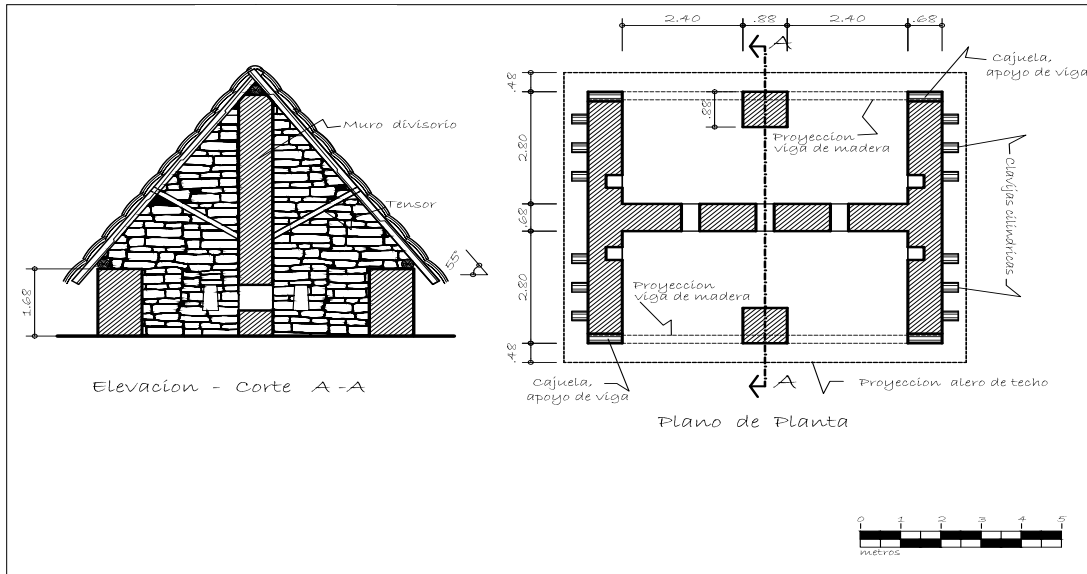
Wayrana doble. Elevación (corte A-A) y plano de planta.
